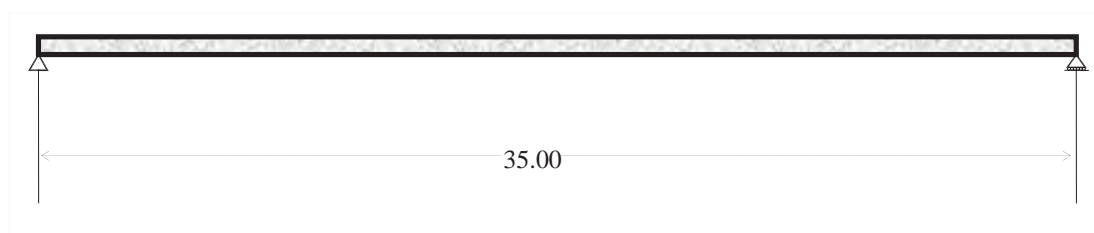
Tipo de apoyo y su longitud entre ellos.
